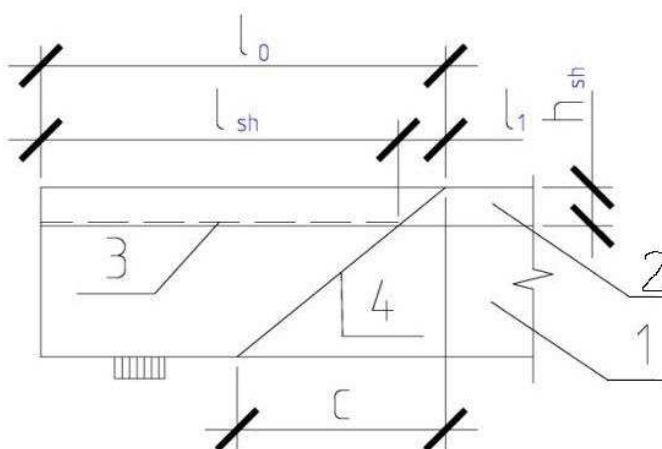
Схема расчетной длины контактного шва: 1- нижний слой бетона; 2- верхний слой бетона; 3- контактный шов, наклонное сечение.
